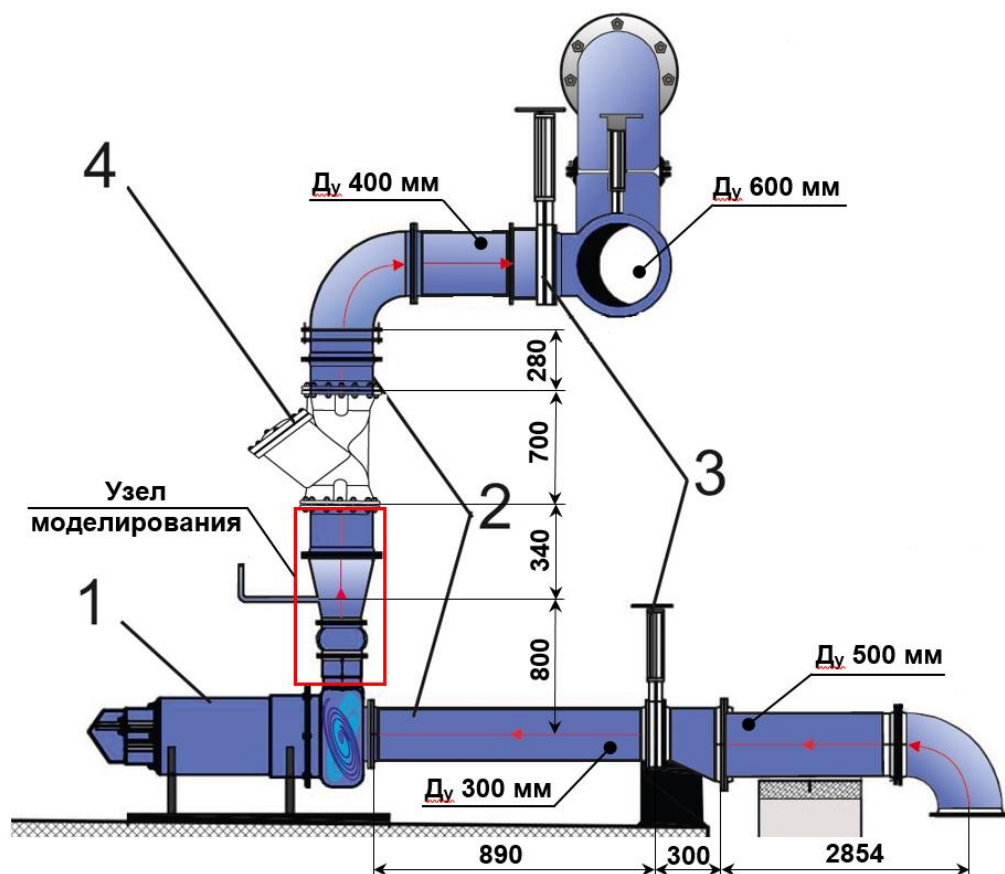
Схема КНС для исследования гидравлического удара: 1 – насосный агрегат; 2 – трубопровод; 3 – шиберная ножевая задвижка; 4 – шаровой обратный клапан
